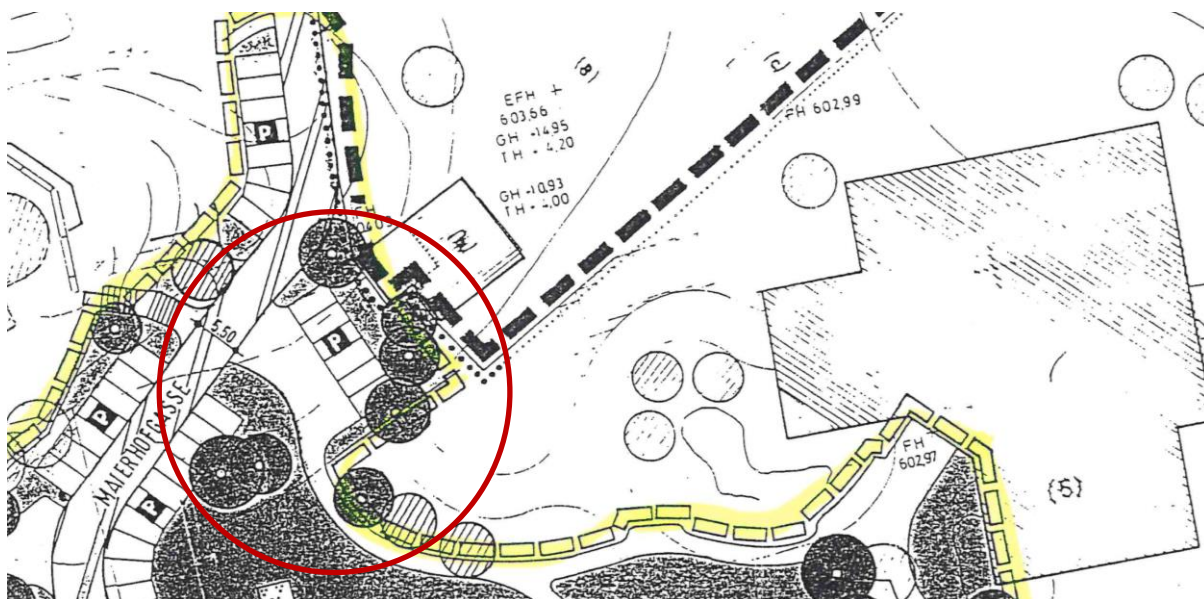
Ausschnitt rechtskräftige Bebauungsplanänderung 1989 (2. Änderung) im Bereich vorliegender Bebauungsplanänderung (Ohne Maßstab)
